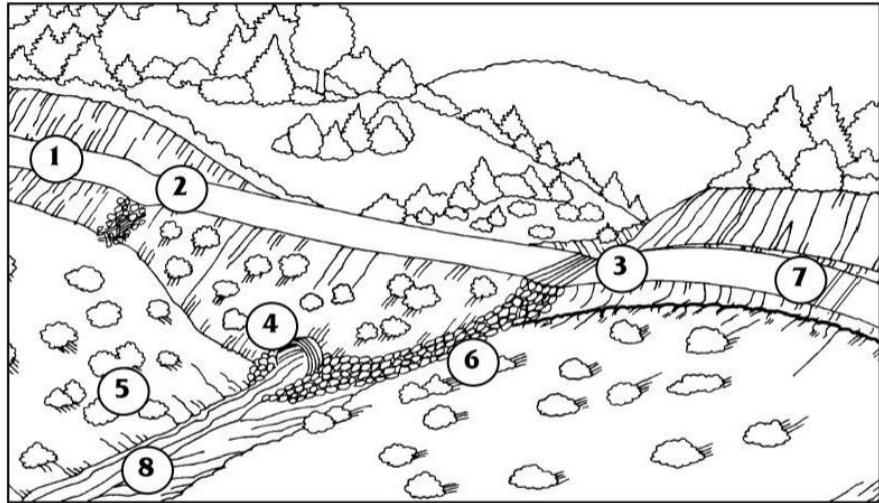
Cruce Natural de Drenaje con una Alcantarilla
